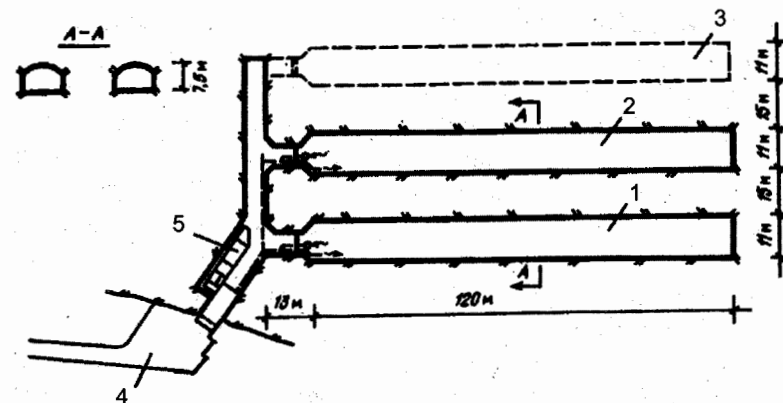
План подземного водохранилища. Квенберг, Норвегия:
